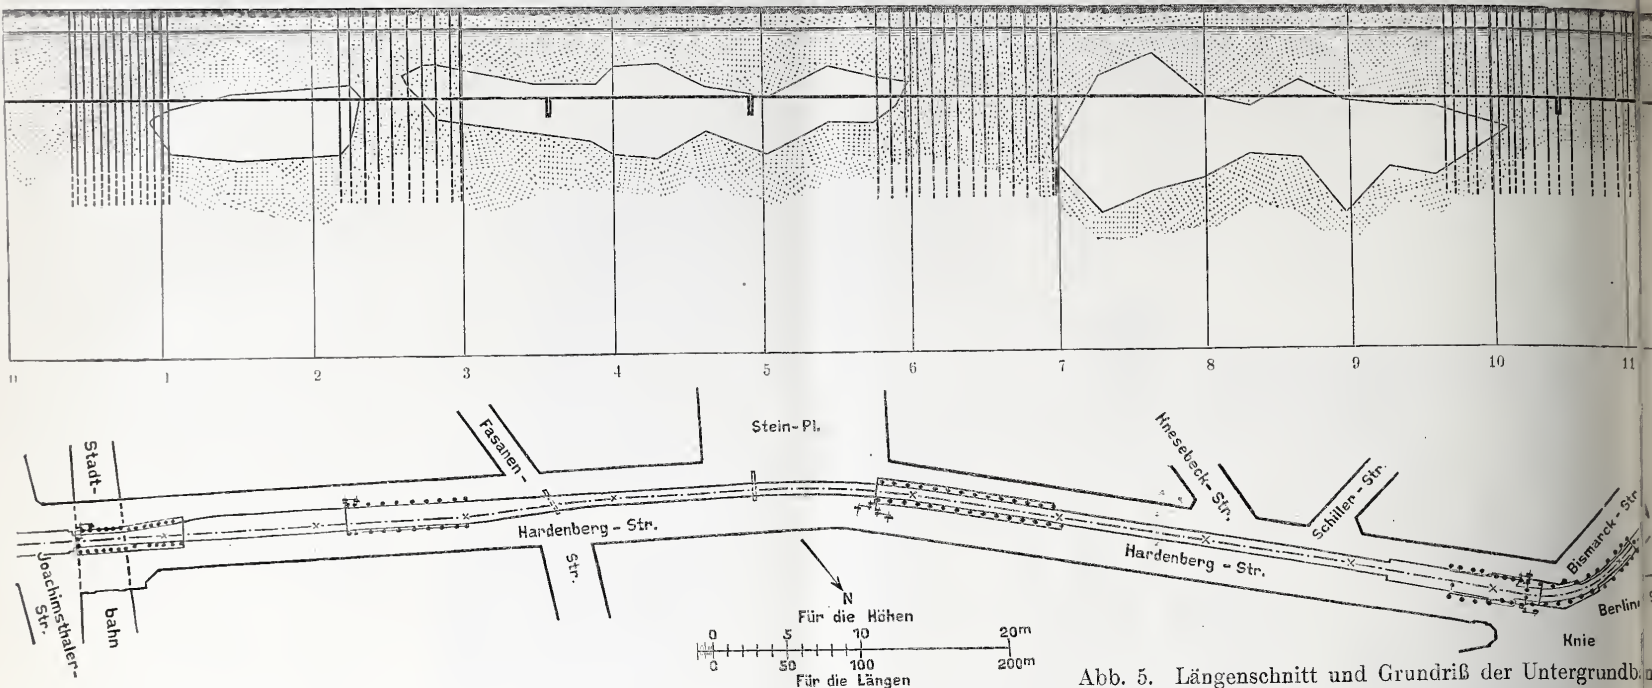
Längenschnitt und Grundriß der Untergrundbauwerke.
